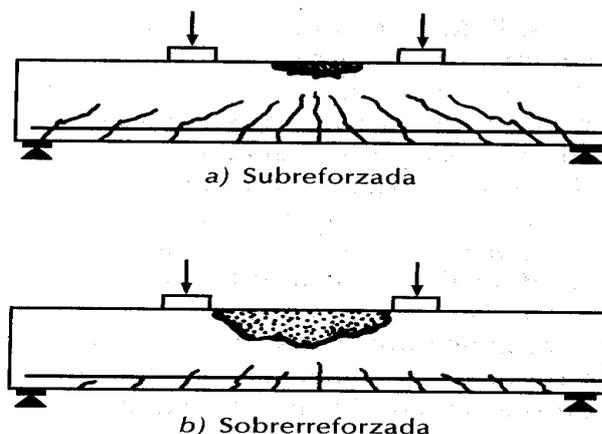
Agrietamiento en la falla de vigas sujetas a flexión.
